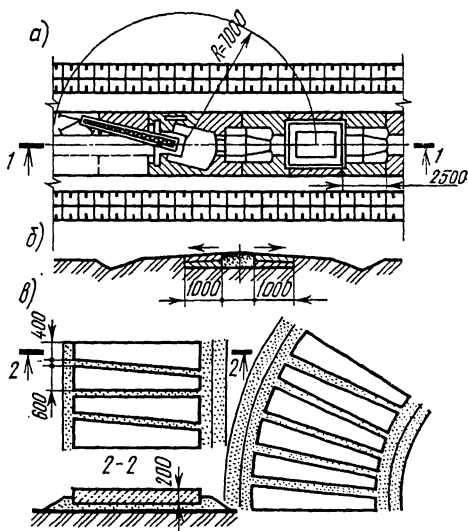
Строительство временной колеиной дороги из решетчатых железобетонных плит: а — укладка плит автомобильным краном; б — поперечный разрез колеиной дороги; в — железобетонные плиты для устройства временных инвентарных дорог
